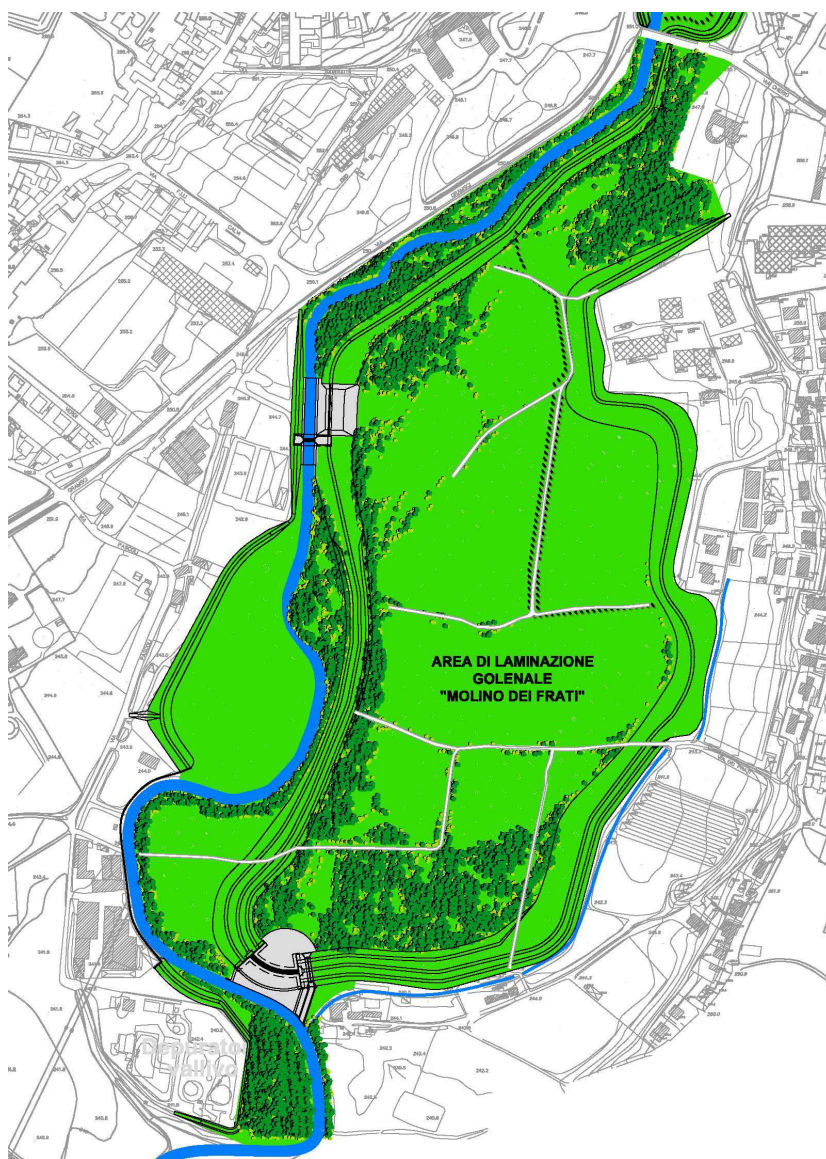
Planimetria dell'area di laminazione golenale "Molino dei Frati"
